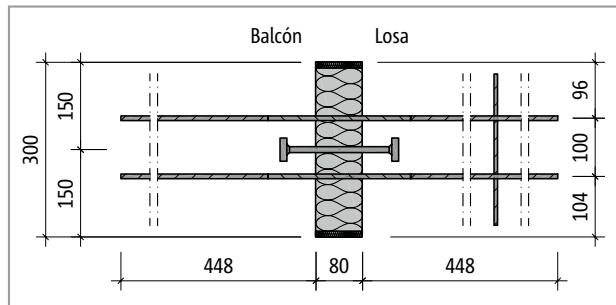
Schöck Isokorb® T tipo Q-P-V1: Plano del producto
